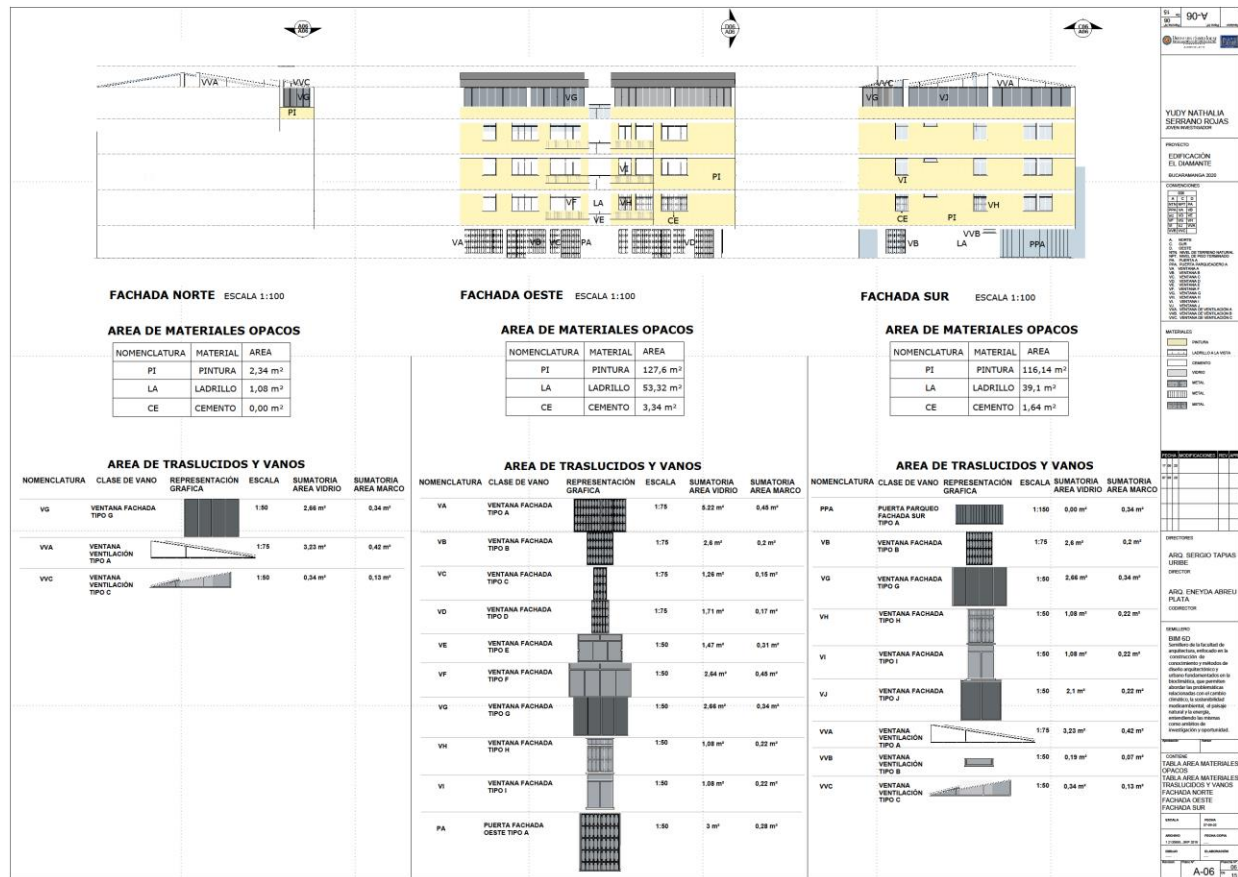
Levantamiento arquitectónico, plancha 6 (Área de materiales opacos, área de materiales traslucidos, fachada norte, fachada oeste y fachada sur) edificación “El Diamante”, 1970.
